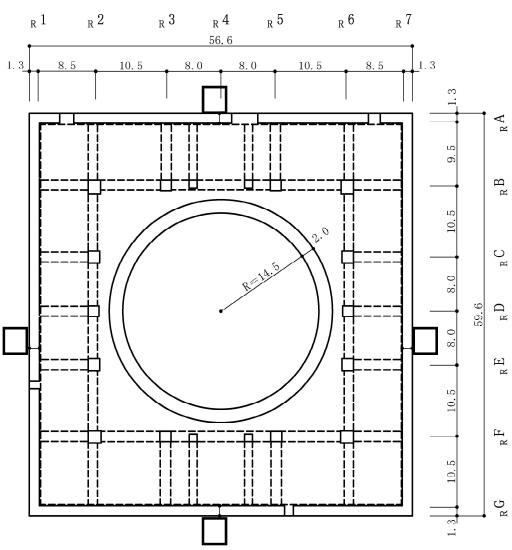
原子炉建屋の概略平面図 (B1F, T.M.S.L.4.8m) (3/9) (単位:m)
